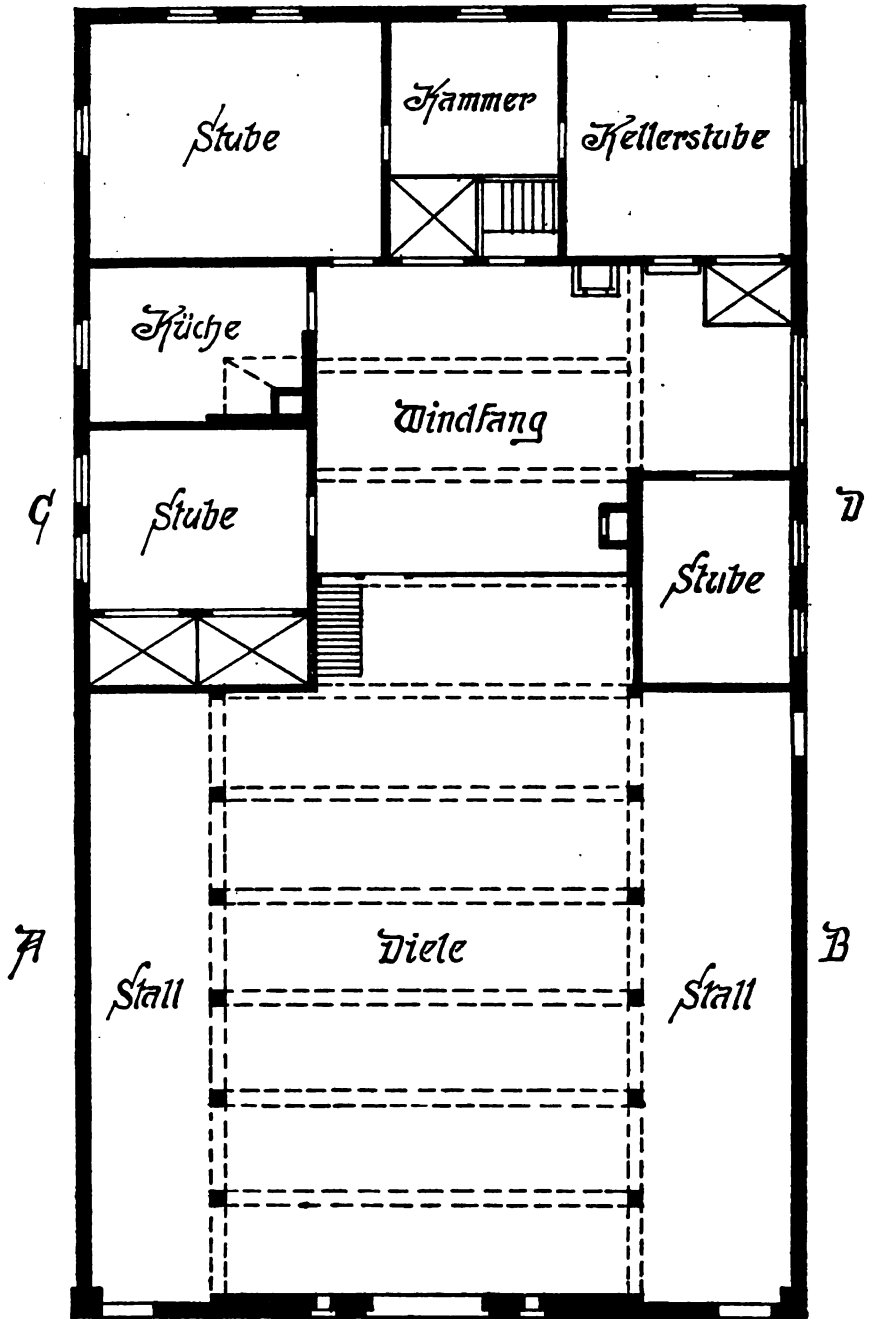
Grundriß des Hauses Wangel's in Wismar.
